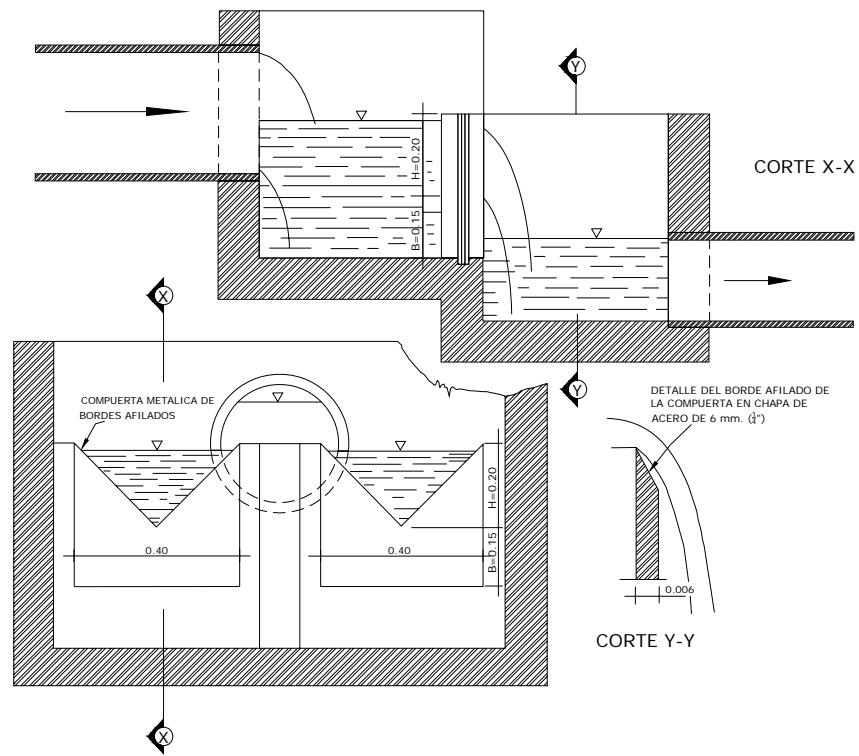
Cortes de la Obra de arte No 1.
